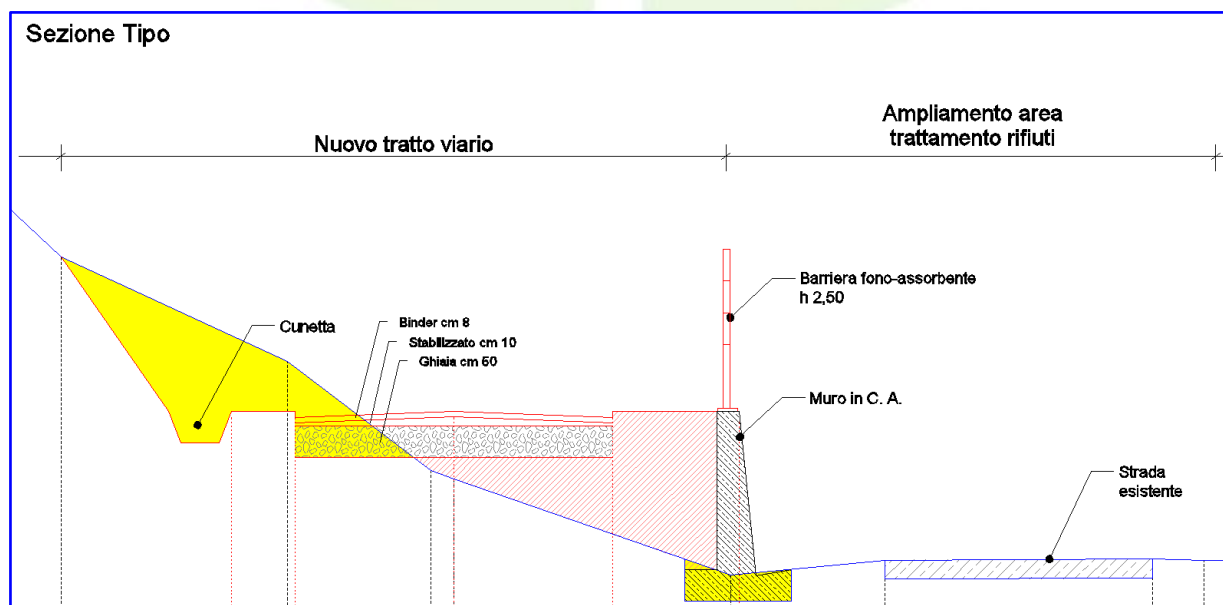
Sezione tipo della nuova viabilità con innalzamento relativo dell'infrastruttura e posizionamento di barriera
